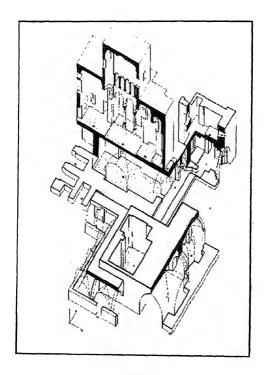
مسقط أفقي لقصر بشناك، الدور الأول، نقلا عن جارسان
